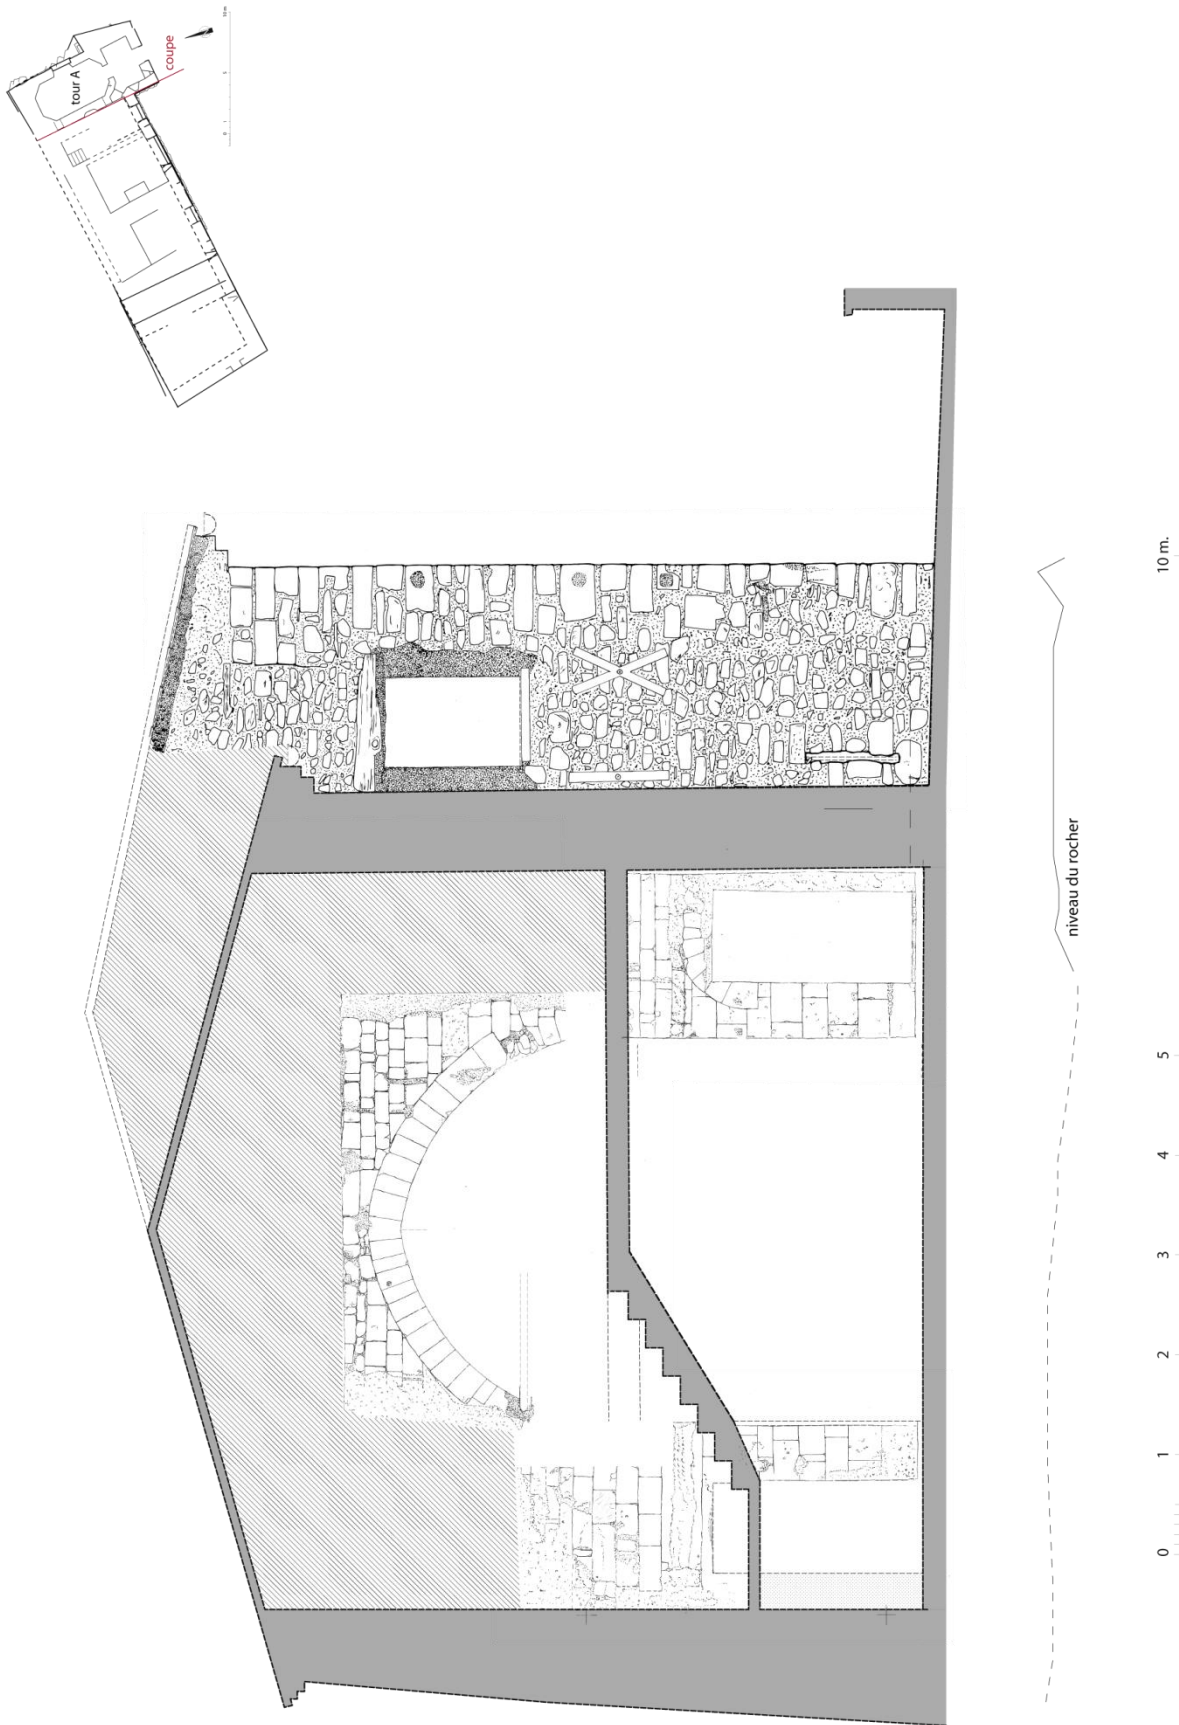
Relevé de l'arc s'ouvrant sur le mur 24 (coupe de la tour A) (relevé et D.A.O. : M.-L. Laharie, M. Varano).
